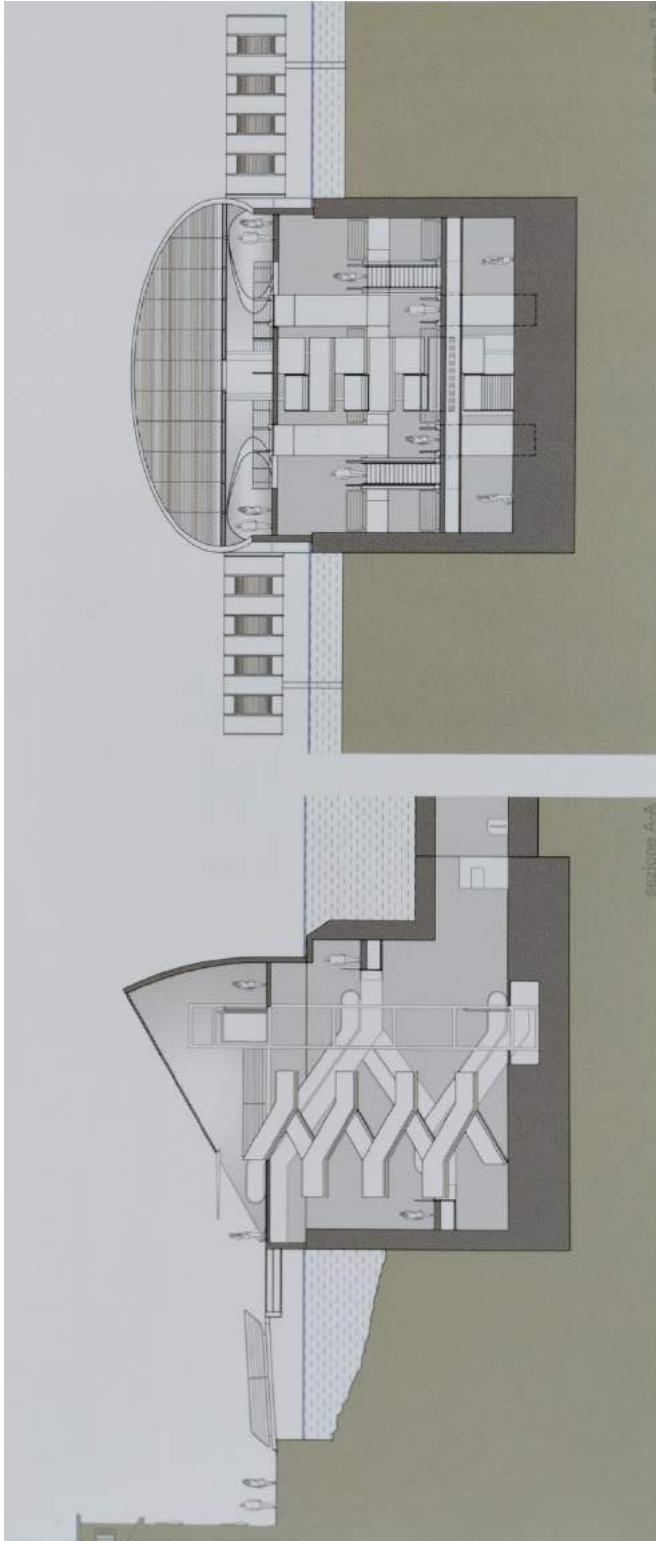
Sezione longitudinale A-A e sezione trasversale B-B sul sistema di accesso
